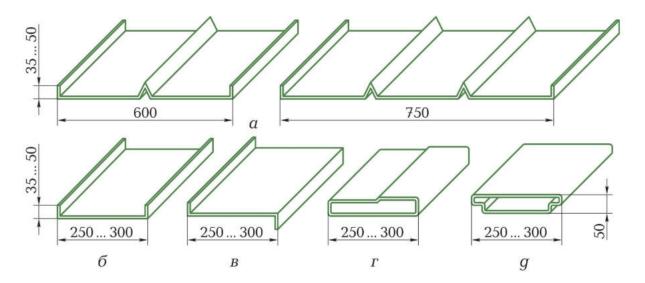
Профильное стекло: a — ребристое; b — швеллерное; b — обрезное; r — коробчатое с одним швом; d — коробчатое с двумя швами
